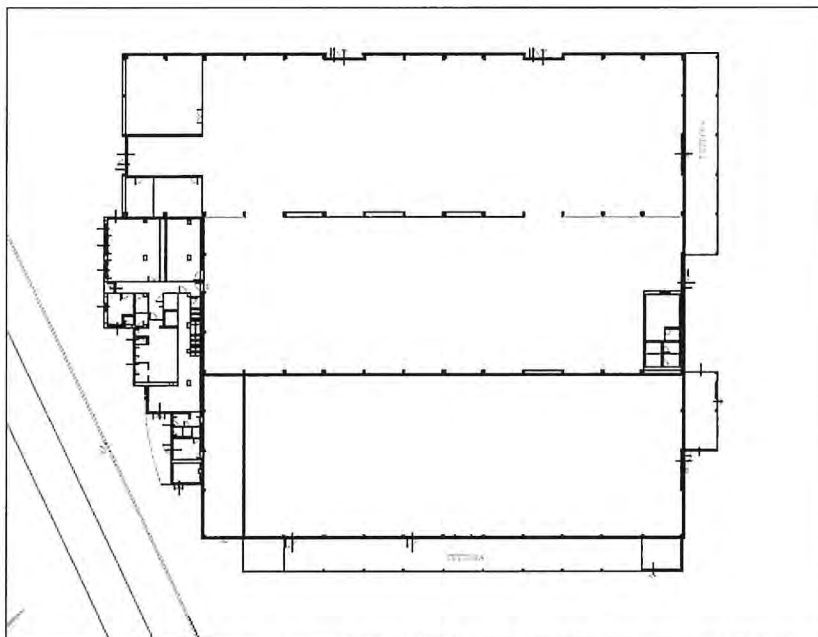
Planimetria stato di fatto (da elaborato 7-PRD1 allegato allo SIA)
